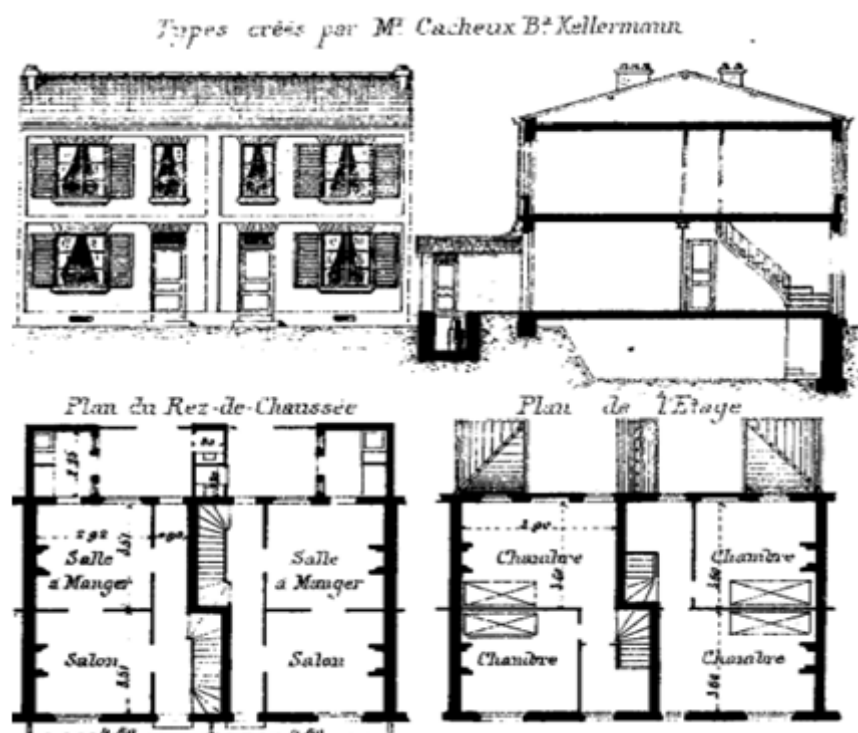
Plan des maisons doubles à étages en ligne.
